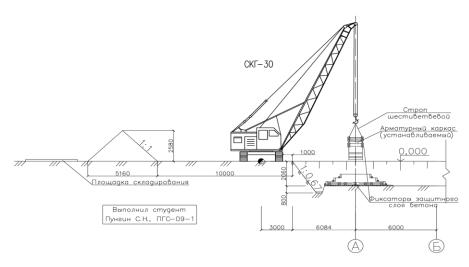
Схема производства работ по захваткам: на захватке № 1 выполняется монтаж арматурных сеток и каркасов, а также сборка щитов опалубки; на захватке №2 — выполнение укладки бетонной смеси в опалубк
